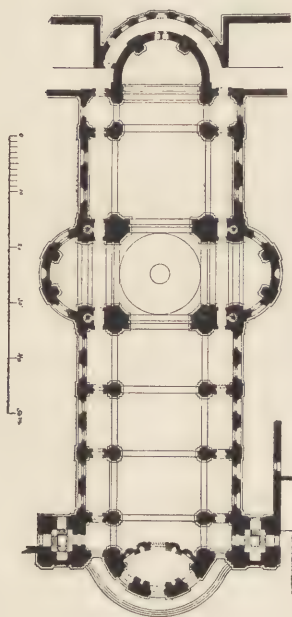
Klosterkirche zu Weingarten, Grundriss.
